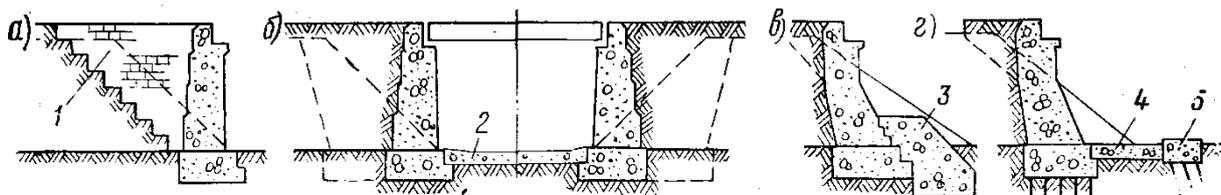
Схемы усиления устоев: а – замена грунта за устоем сухой кладкой; б – распорной перемычкой между фундаментами устоев (в местах малой длины); в – устройством контрфорса; г – железобетонной распоркой с упором;
